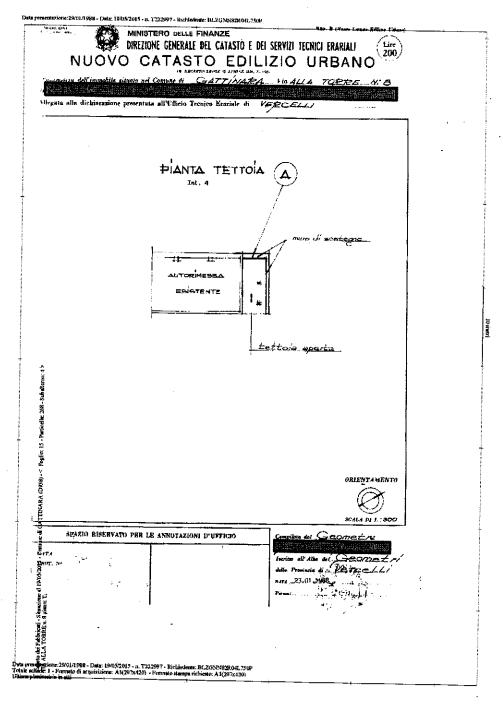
planimetria immobile 3, non conforme allo stato di fatto
